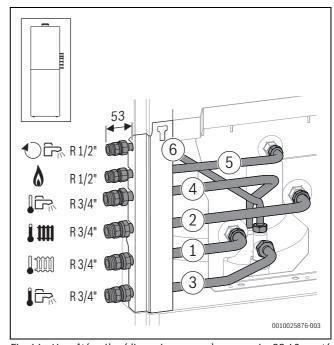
Vue côté arrière (dimensions en mm) : accessoire CS 10 monté sur le côté droit
